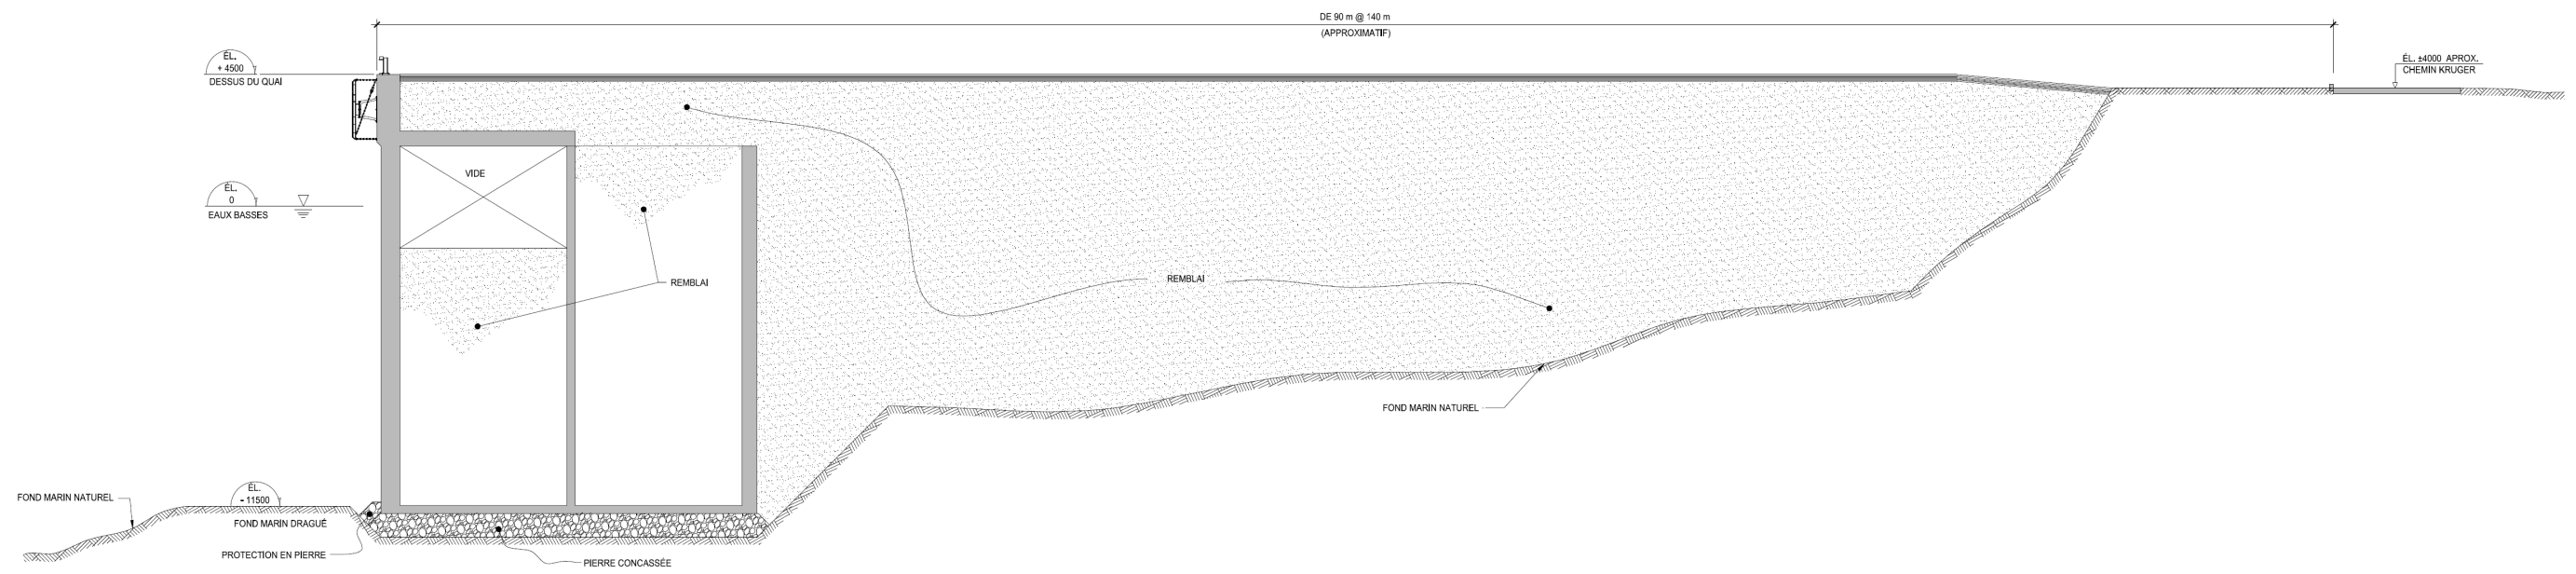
Coupe-type de la variante 1 -Caisson de béton et remblai jusqu'à la rivière
